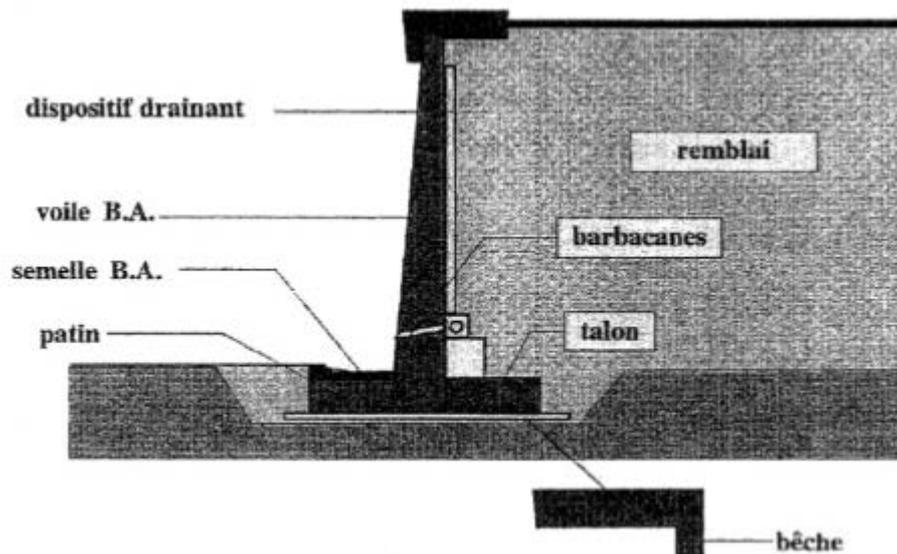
Morphologie d'un mur en béton armé encastré sur semelle
